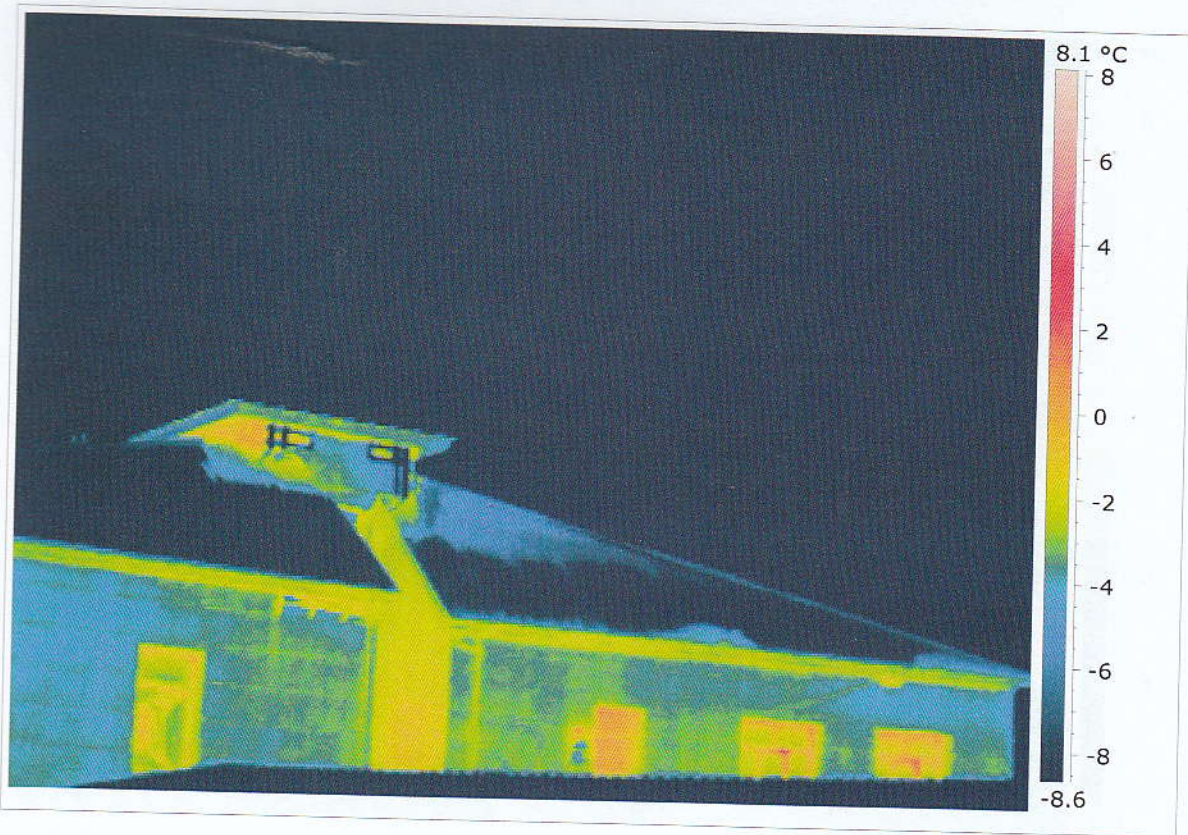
Фрагмент ограждающих конструкций здания снаружи
